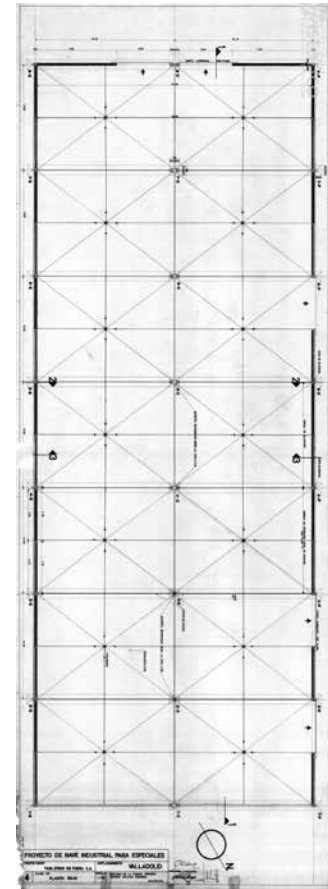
Nave de Tableros Especiales. Plano de Planta Baja.
